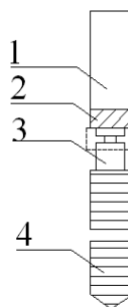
Пересадка фундамента на вдавливаемые сваи
